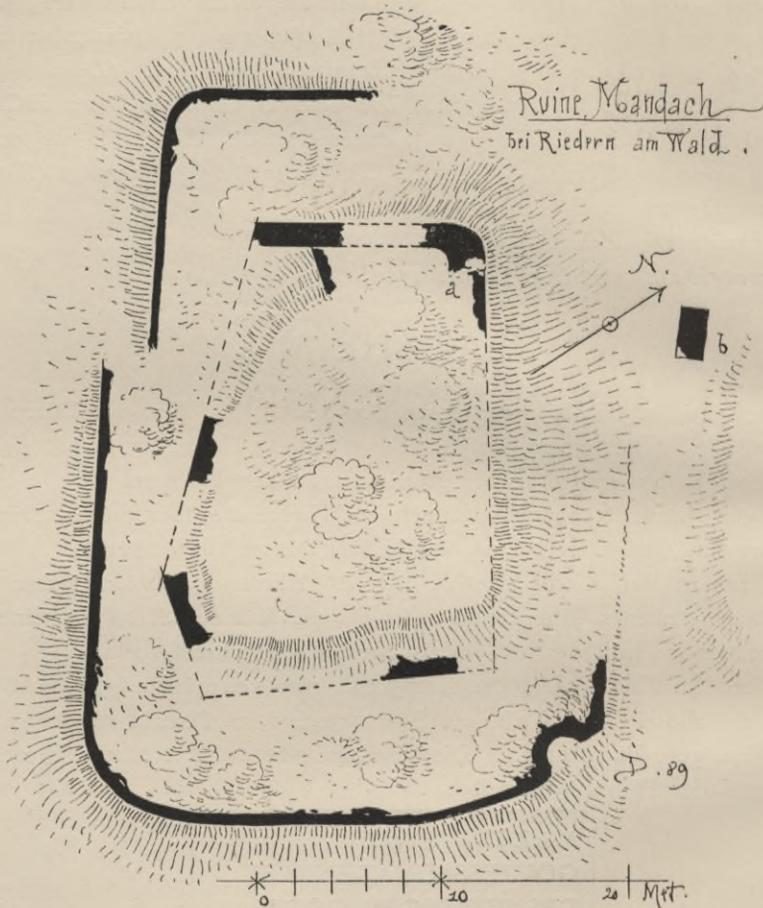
Mandach. Grundriss der Burgruine.
